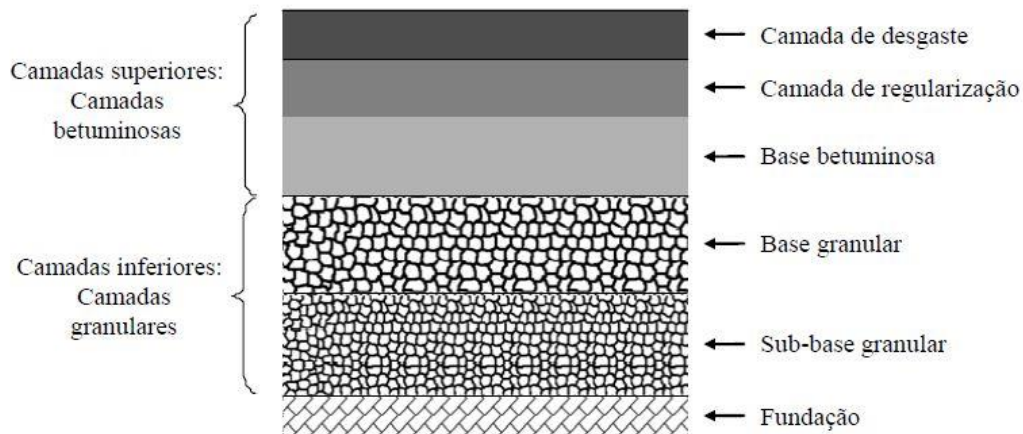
Constituição tipo de um pavimento flexível (Silva, 2005)
